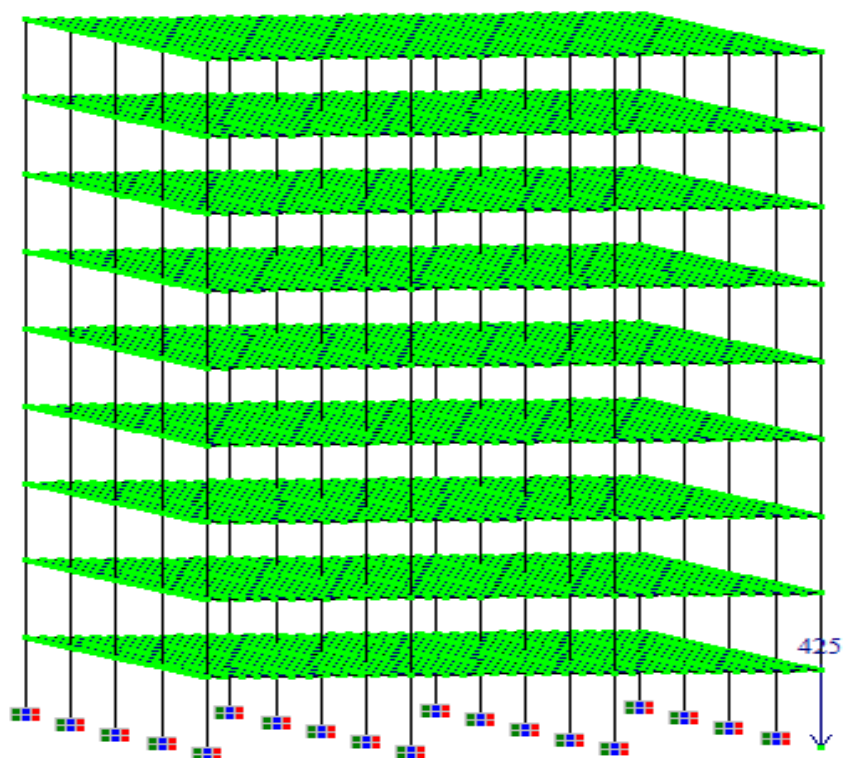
Schéma illustratif du modèle d'étude du bâtiment avec planchers sans hourdis à 9 niveaux avec un chargement vertical sur le poteau d'angle
